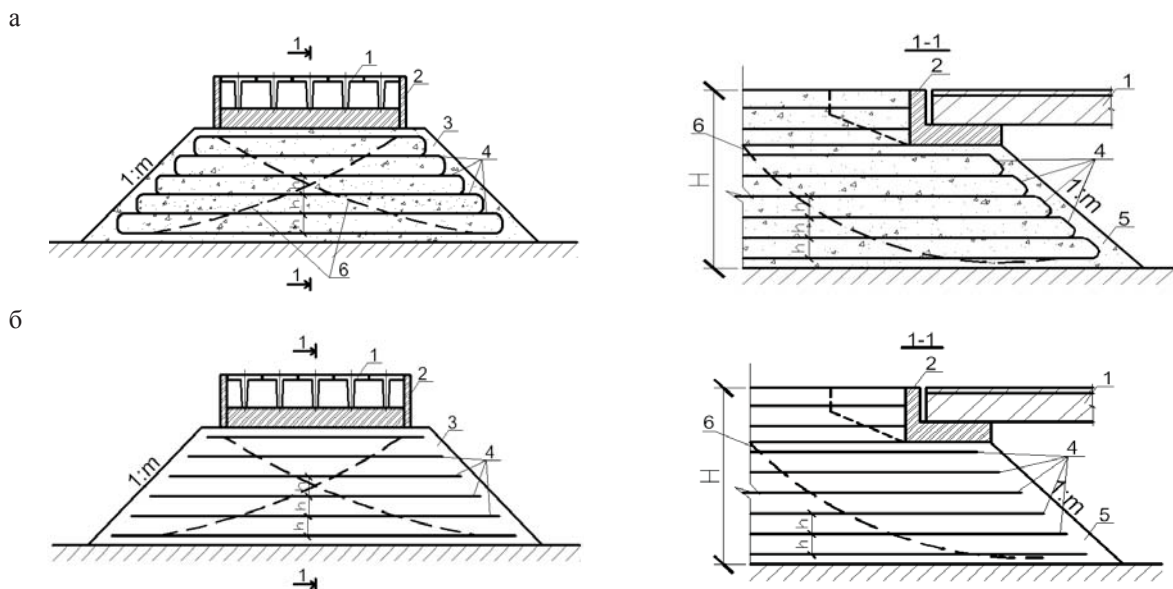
Схема армирования насыпи с устоем диванного типа: а – несвязные грунты; б – связные грунты; 1 – пролетное строение; 2 – устой диванного типа; 3 – насыпь к подходу моста; 4 – армирующие полотнища; 5 – конус насыпи; 6 – наиболее опасные потенциальные поверхности обрушения неармированной насыпи; h – шаг армирования; H – высота армированного грунта
